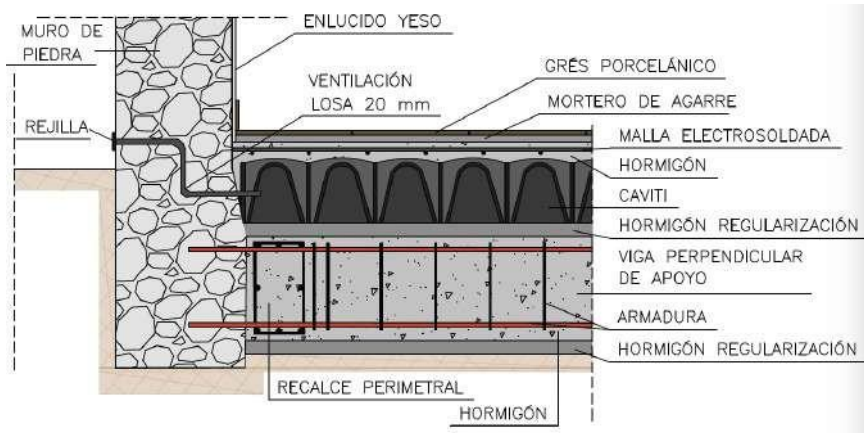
Propuesta de intervención de la cimentación de muros. Fuente propia
